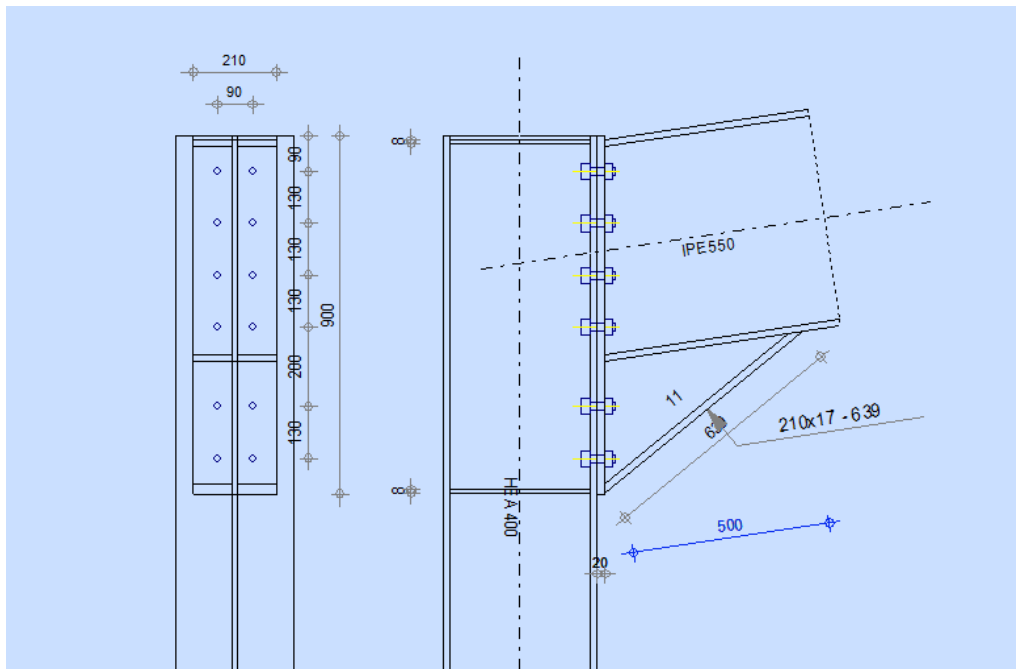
Représentation de l'assemblage Poteau –Traverse.
